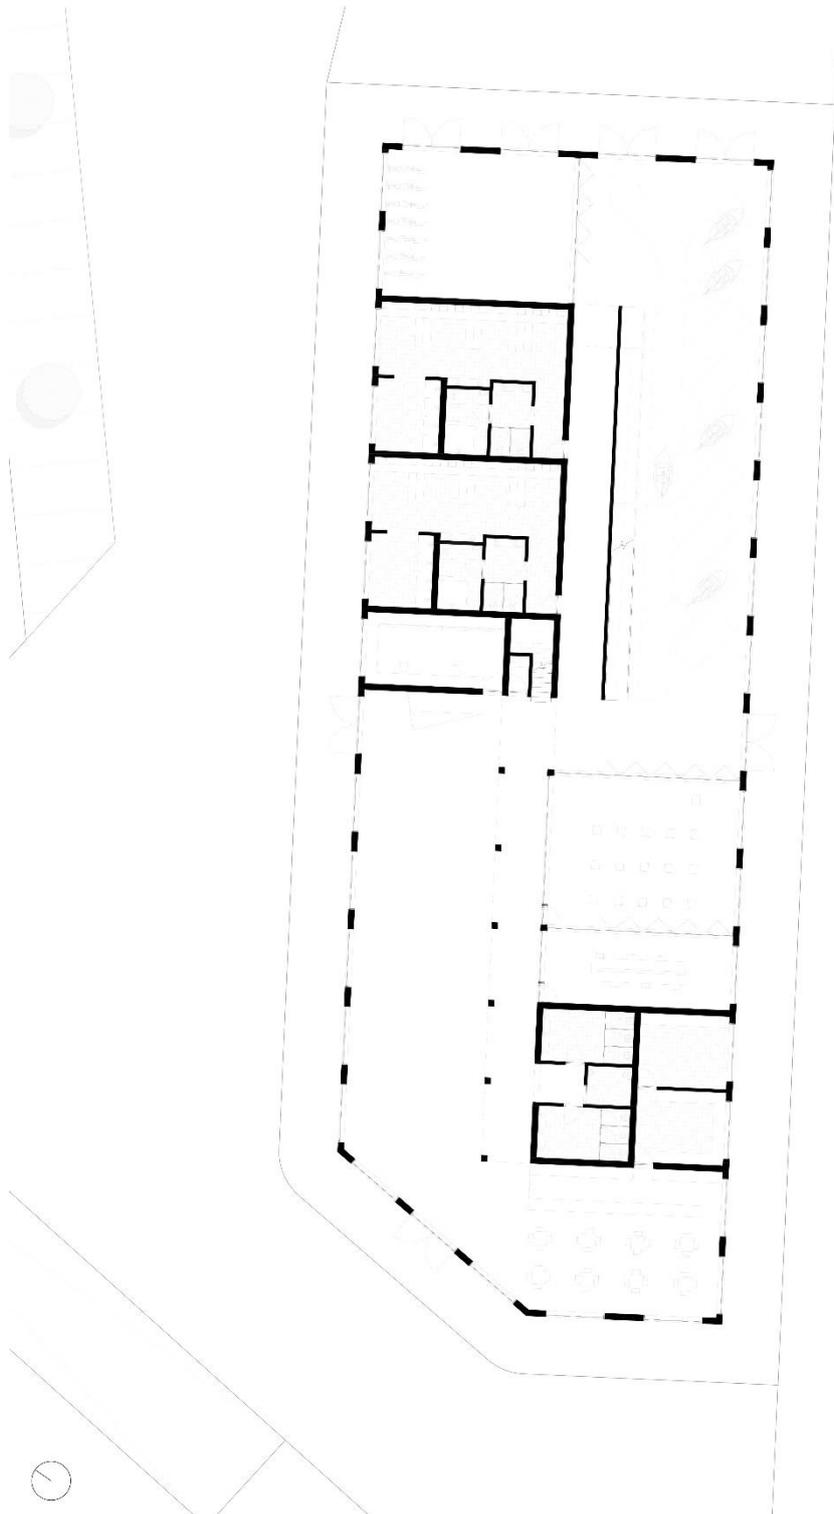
Representação em planta do piso térreo do edifício dedicado à prática da vela. Redução da escala 1:100.
